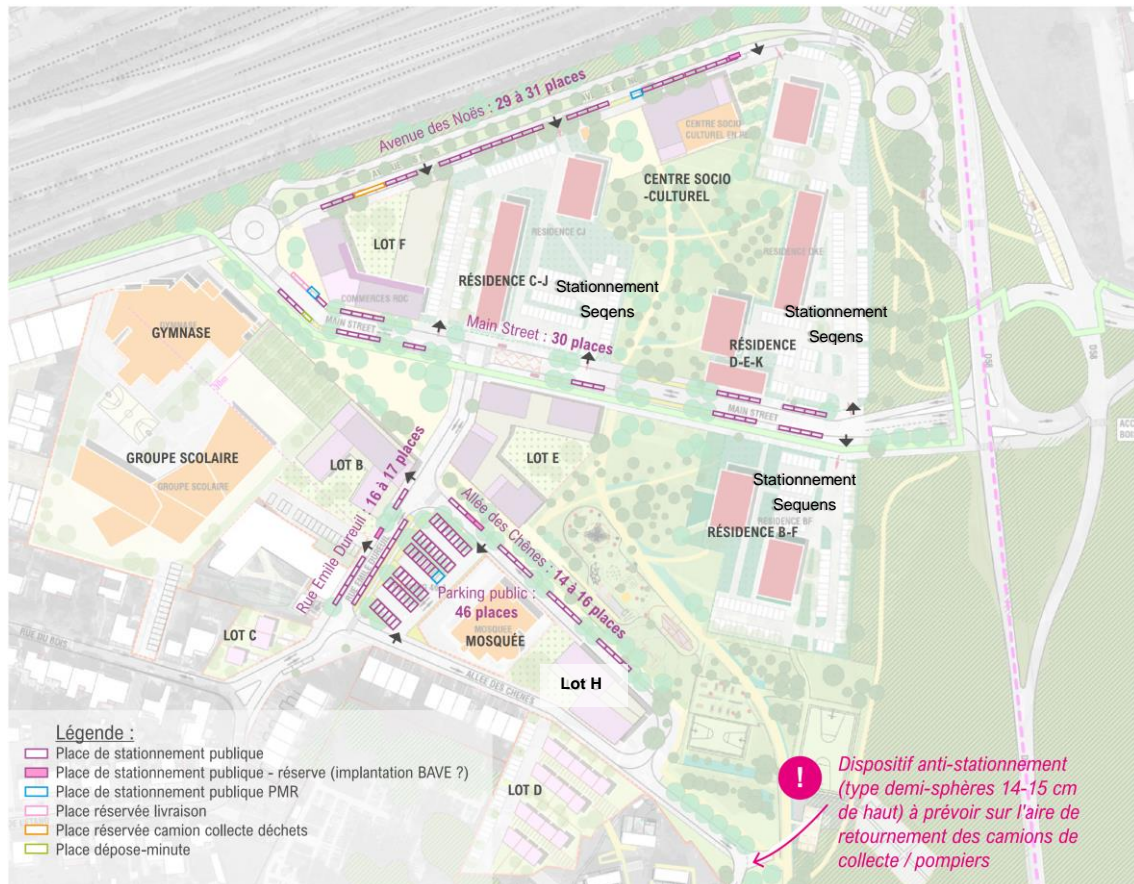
Plan du stationnement public au sein du périmètre du projet (Source : La Fabrique Urbaine, Plan guide, 01/2025)
